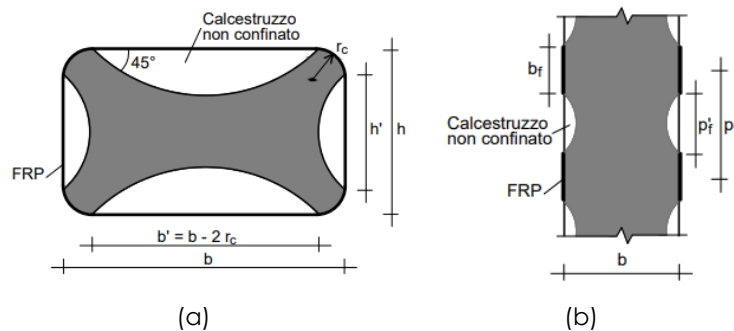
Confinamento di elementi in calcestruzzo armato: a) porzione di sezione trasversale efficacemente confinata, b) sezione longitudinale efficacemente confinata.
